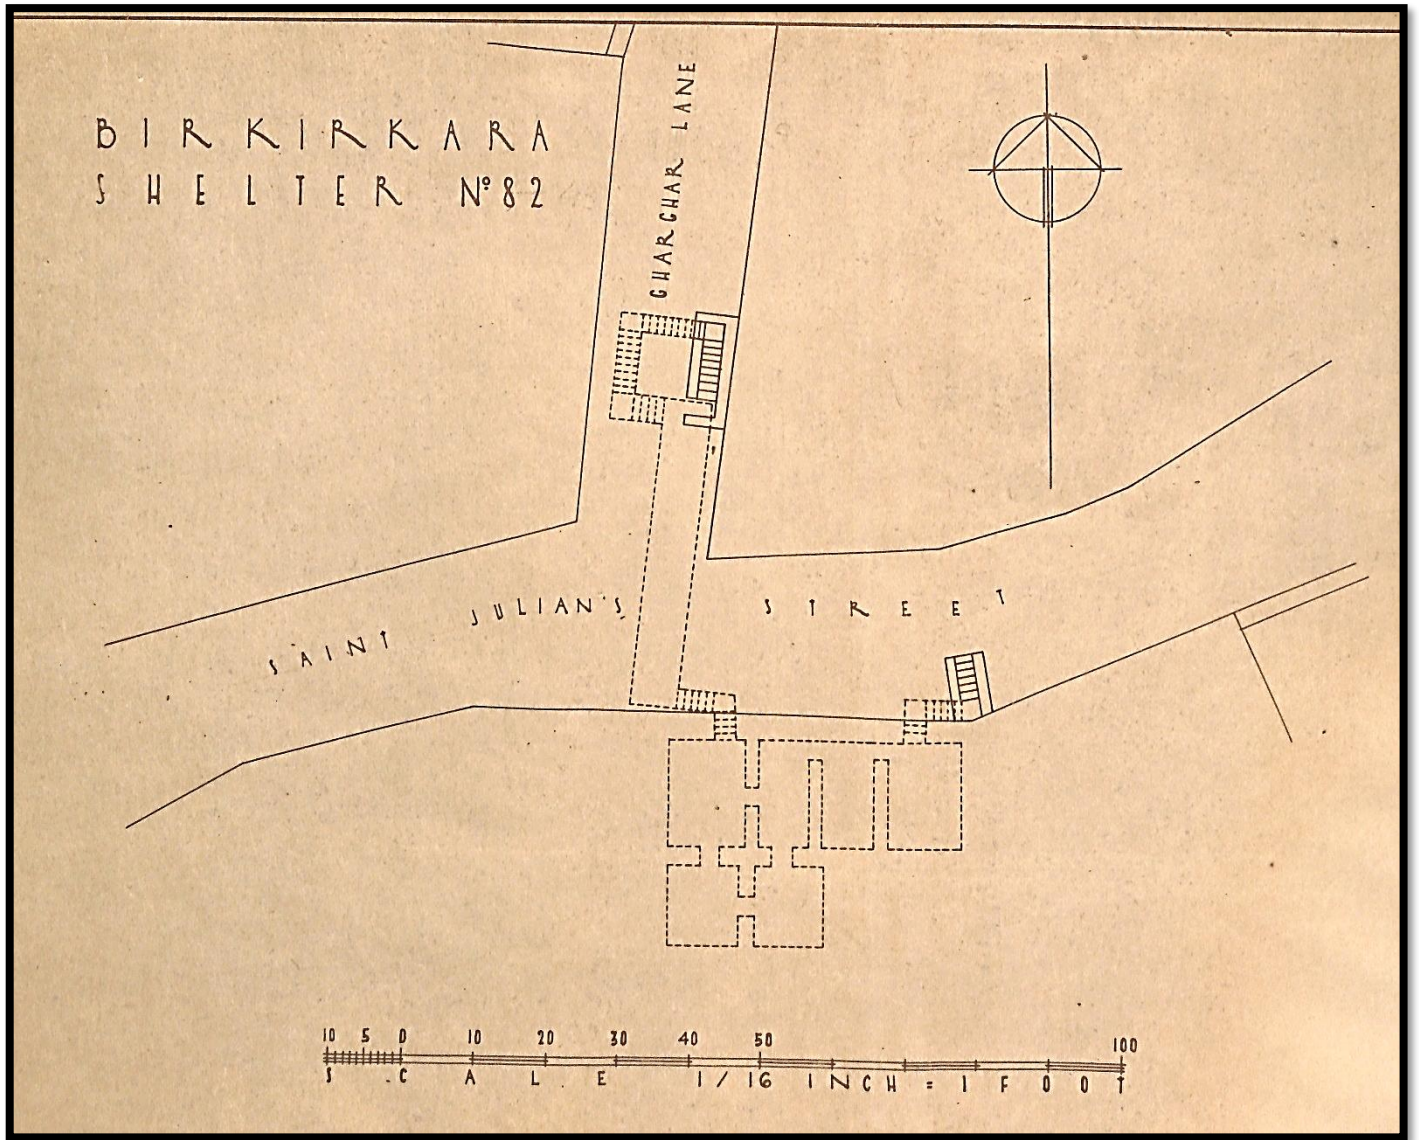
Planta do Abrigo nº82 (45) "Saint Julian's Street – Church Lane."
